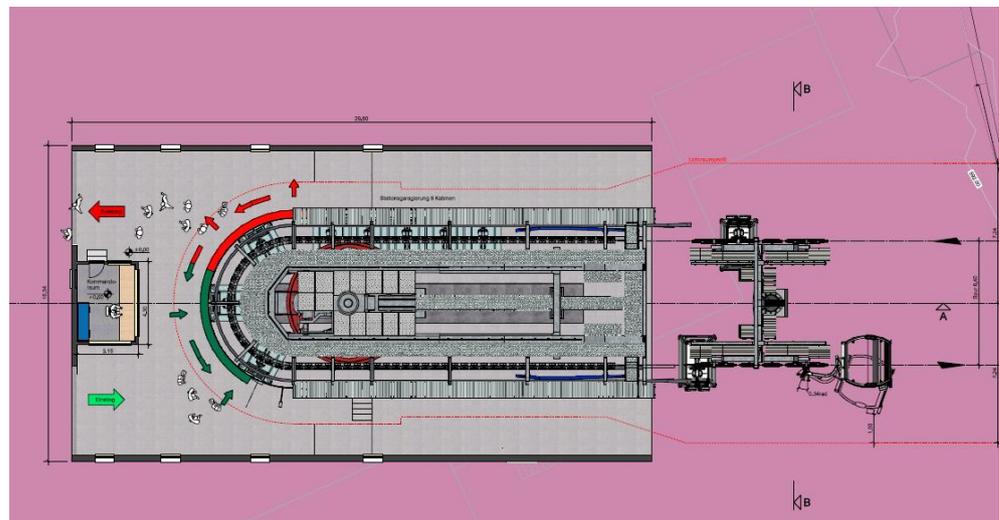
Grundriss Talstation Chur ohne Nebennutzungen
